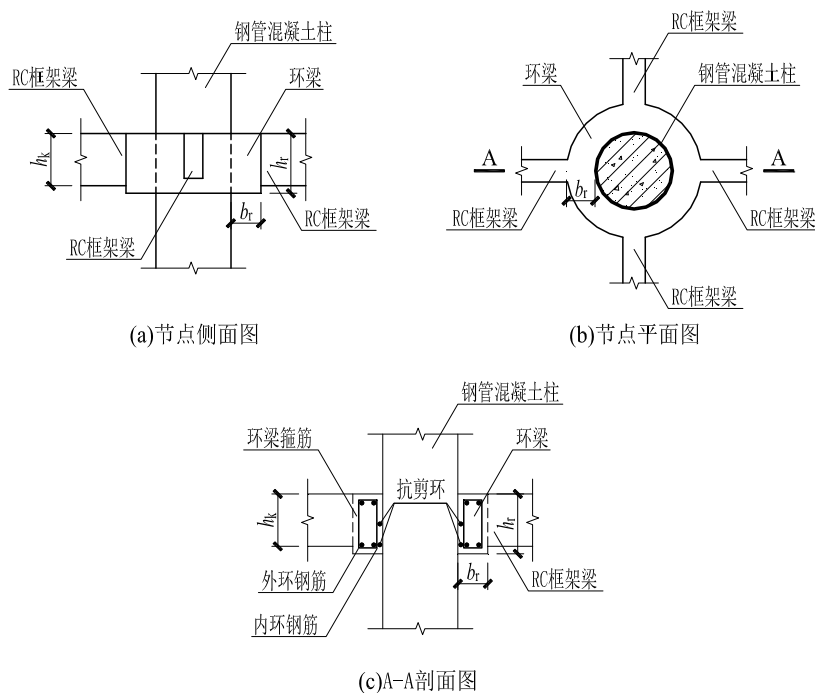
RC 梁-圆钢管混凝土柱节点简图
